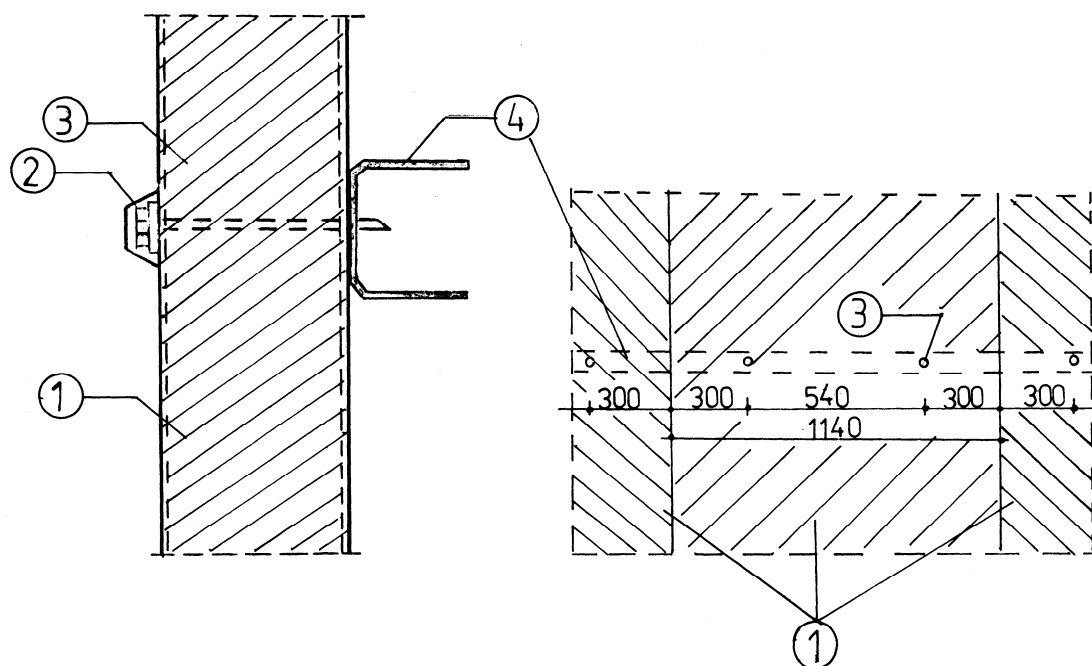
Połączenie płyt warstwowych dachowych SANDWICH typu Pdn
